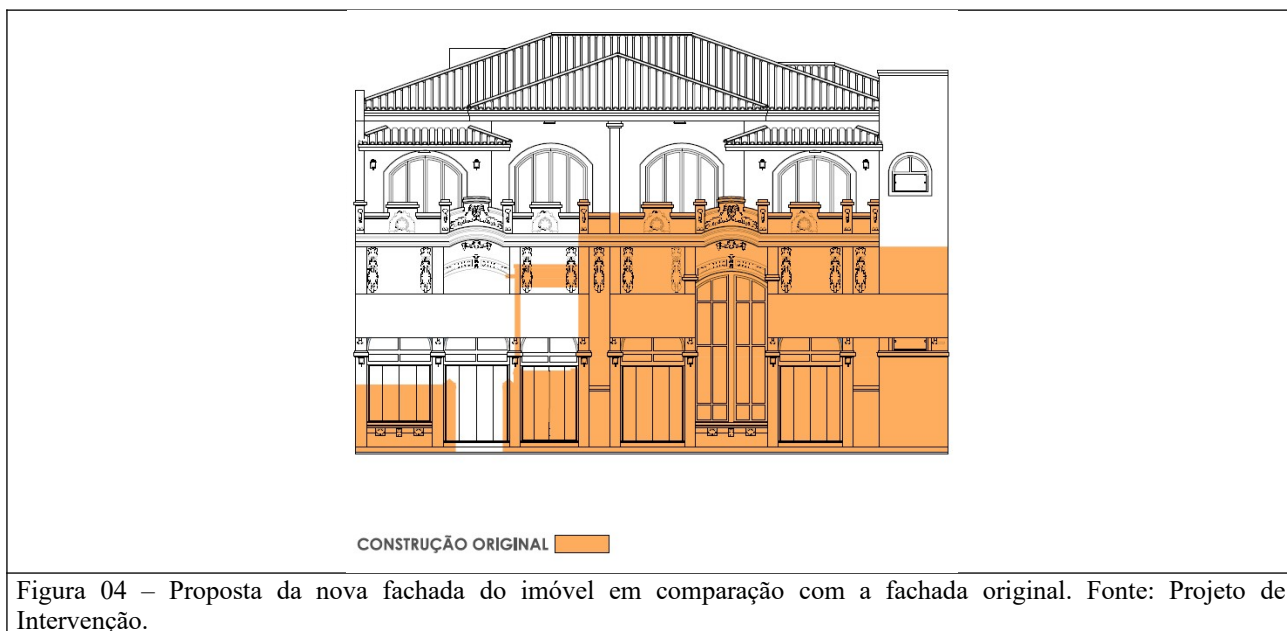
Proposta da nova fachada do imóvel em comparação com a fachada original. Fonte: Projeto de Intervenção.
